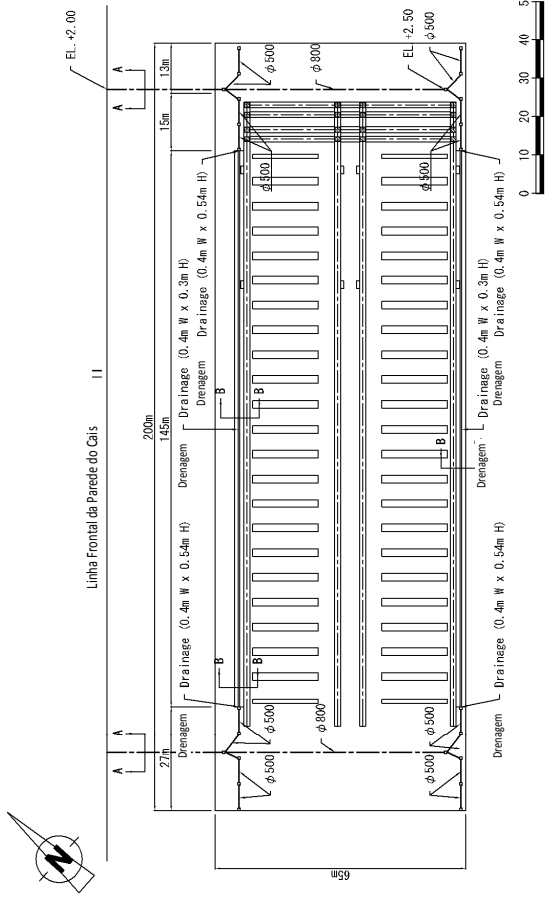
Detalhes da Pavimentação no Pátio de Contêineres
